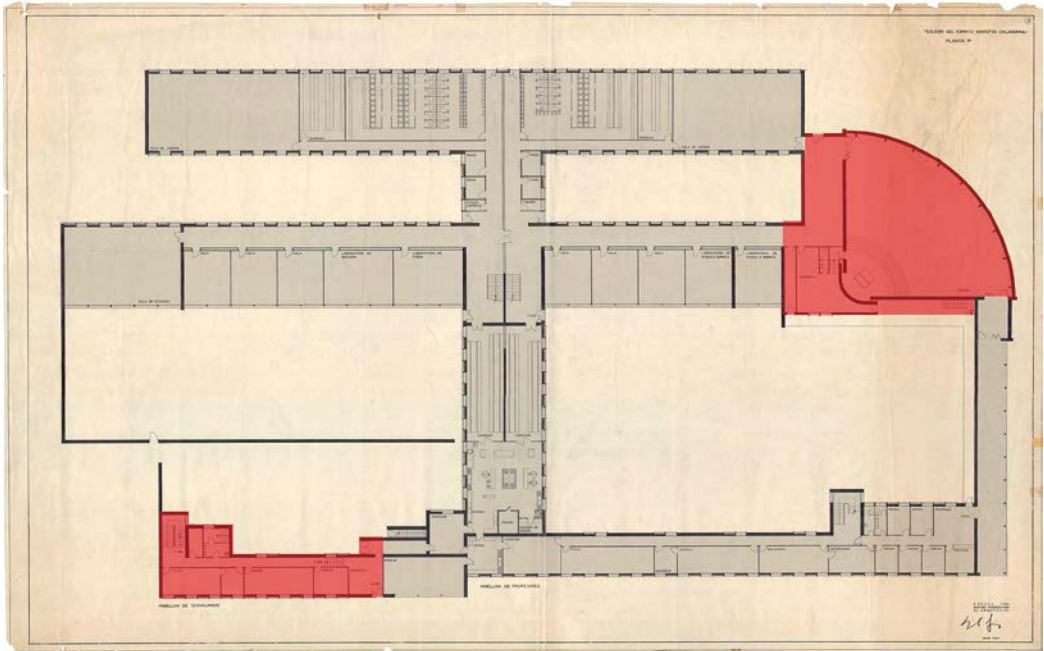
Plano de la planta baja del proyecto con la edificación proyectada (en gris), y no ejecutada (en rojo) correspondiente a la zona de las religiosas y a la iglesia. Imagen coloreada por Isabel Muñoz a partir de una planta del proyecto. (AFF, sig. 152).
